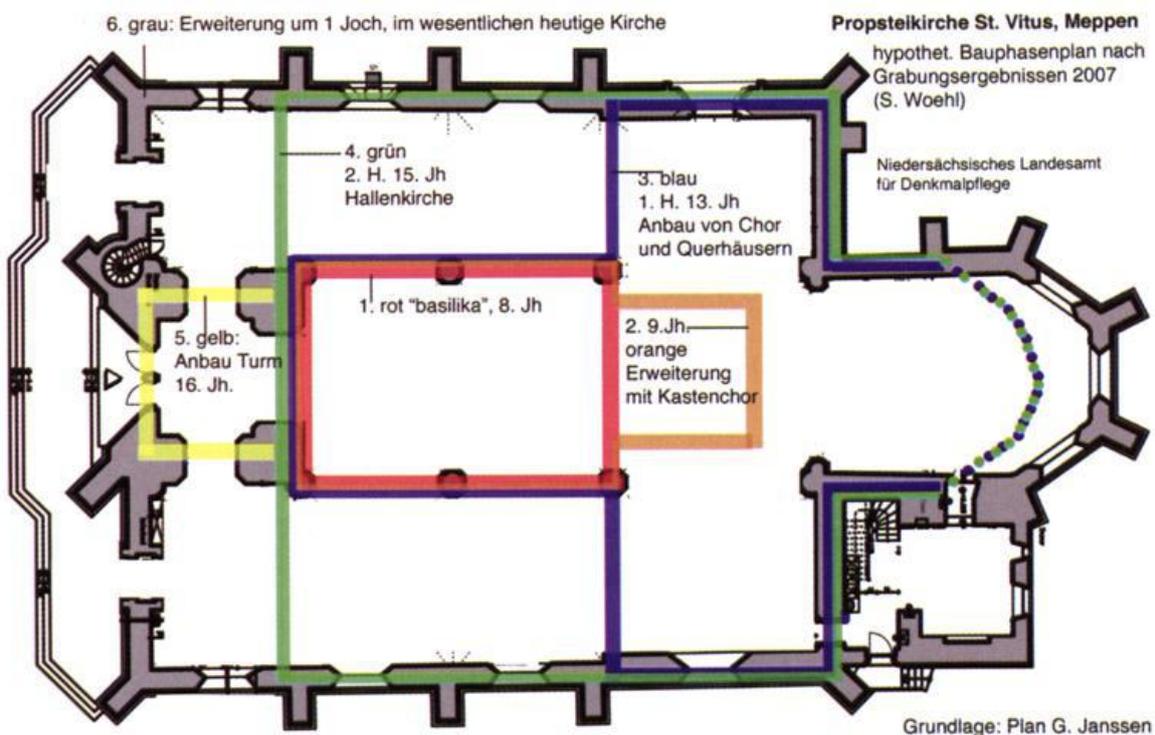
Grundrisse der St. Vituskirche Meppen aus verschiedenen Jahrhunderten.
